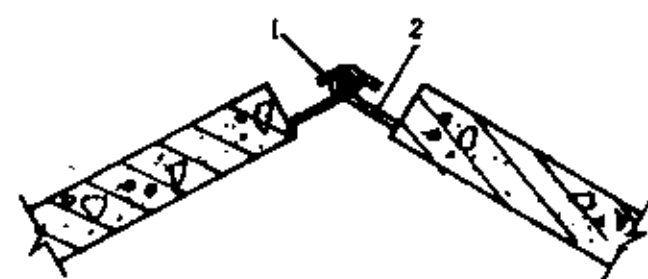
上折缝伸出横向钢筋与附加钢筋连接示意
